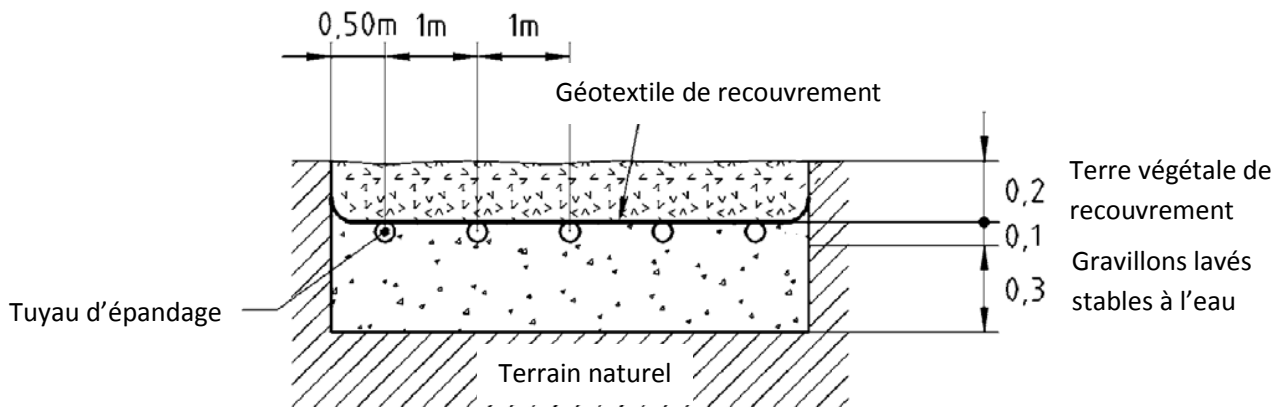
Exemple d'un lit d'infiltration – coupe transversale
